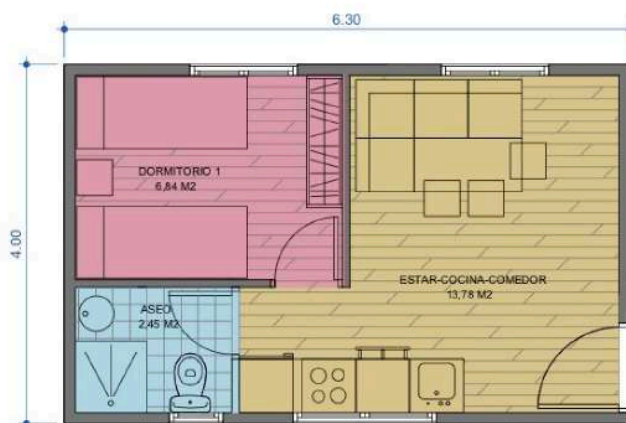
IMAGEN MINI CASA DOLBI 25 H1 PIEDRA
